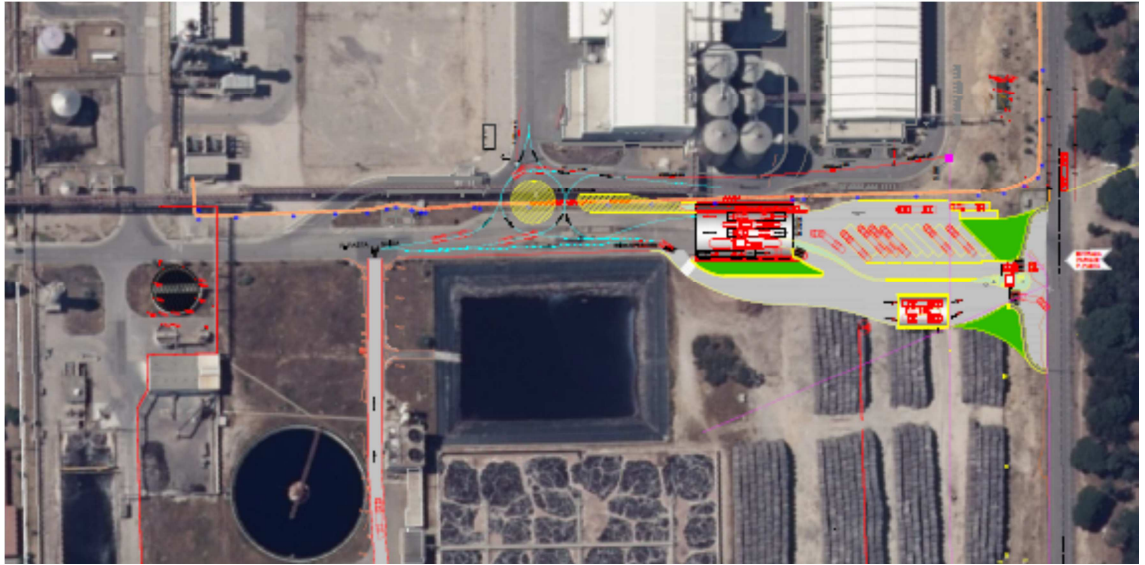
Planta do Complexo Fabril com novos fluxos de Mercadorias
